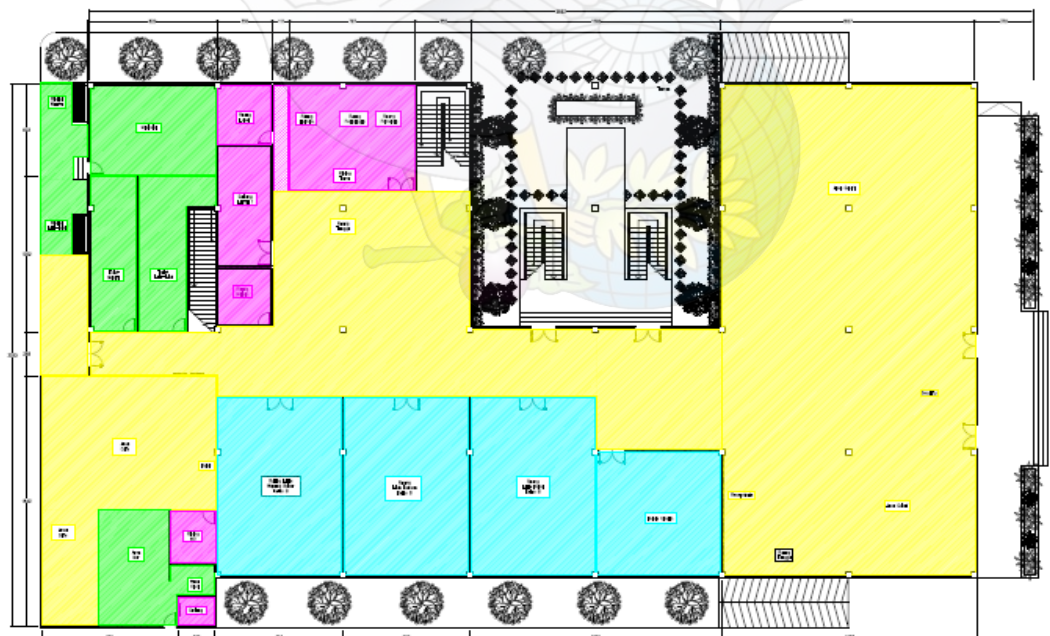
Grouping Zoning Lantai 2 Alternatif 1
